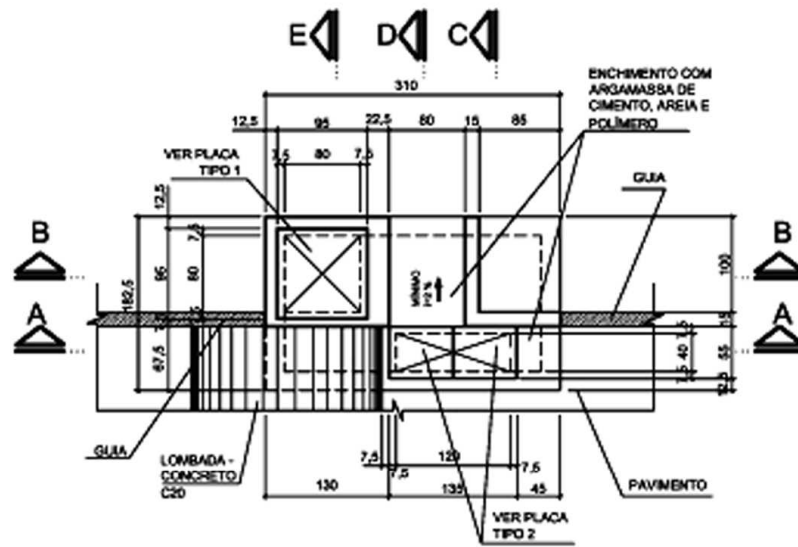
Implantação das Barragens para Retenção de Sólidos, no Rodoanel Oeste. Planta e elevação.
